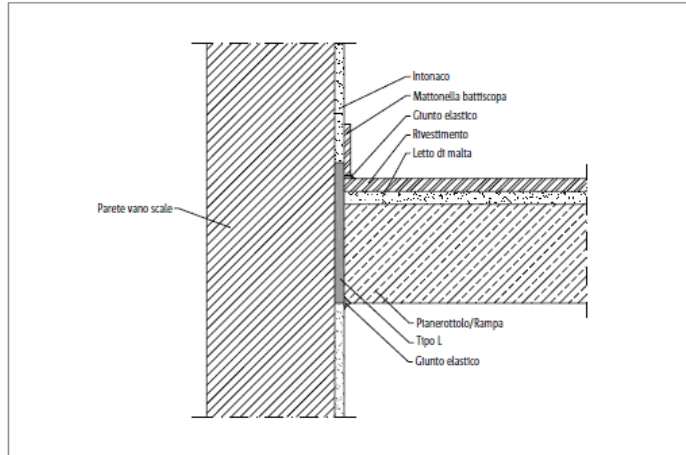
Schöck Tronsole® tipo L: sezione costruttiva - scale in opera
